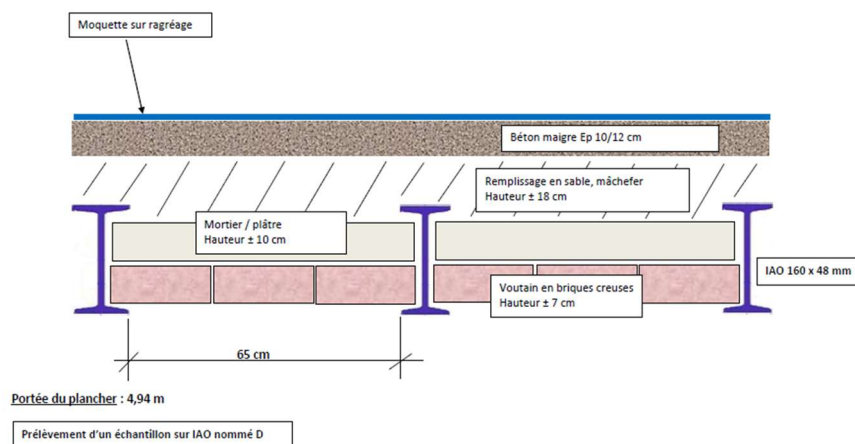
Relevé du plancher bas RDC au sondage SD3 bis, au niveau de la sortie de secours existante sur la façade Nord. Rapport Rincenc BTP
